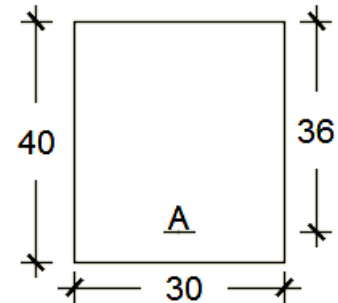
N°17 : Section de calcul de la poutre en travée.
